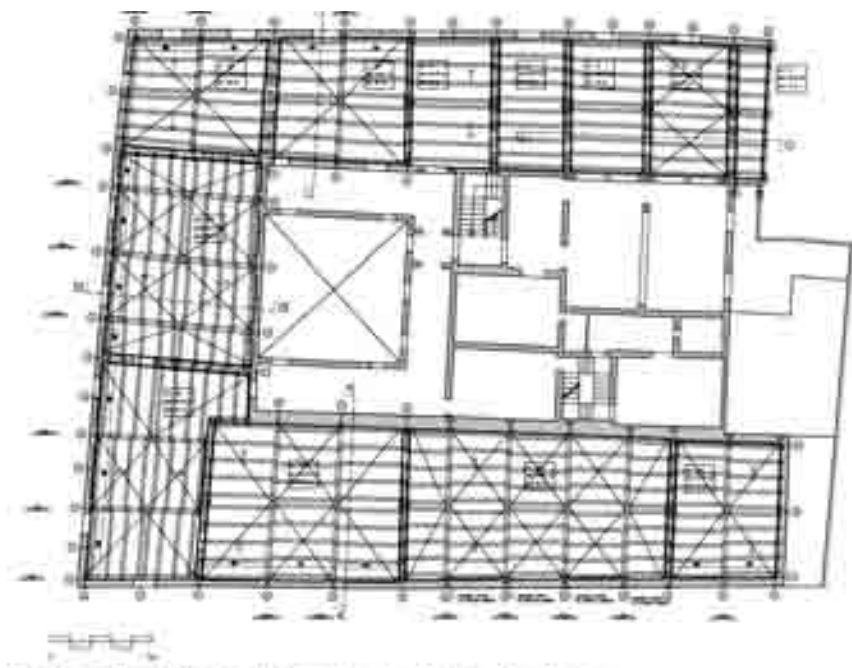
Trapani, Palazzo Riccio di San Gioacchino, schema planimetrico con indicati gli interventi sulle coperture.
